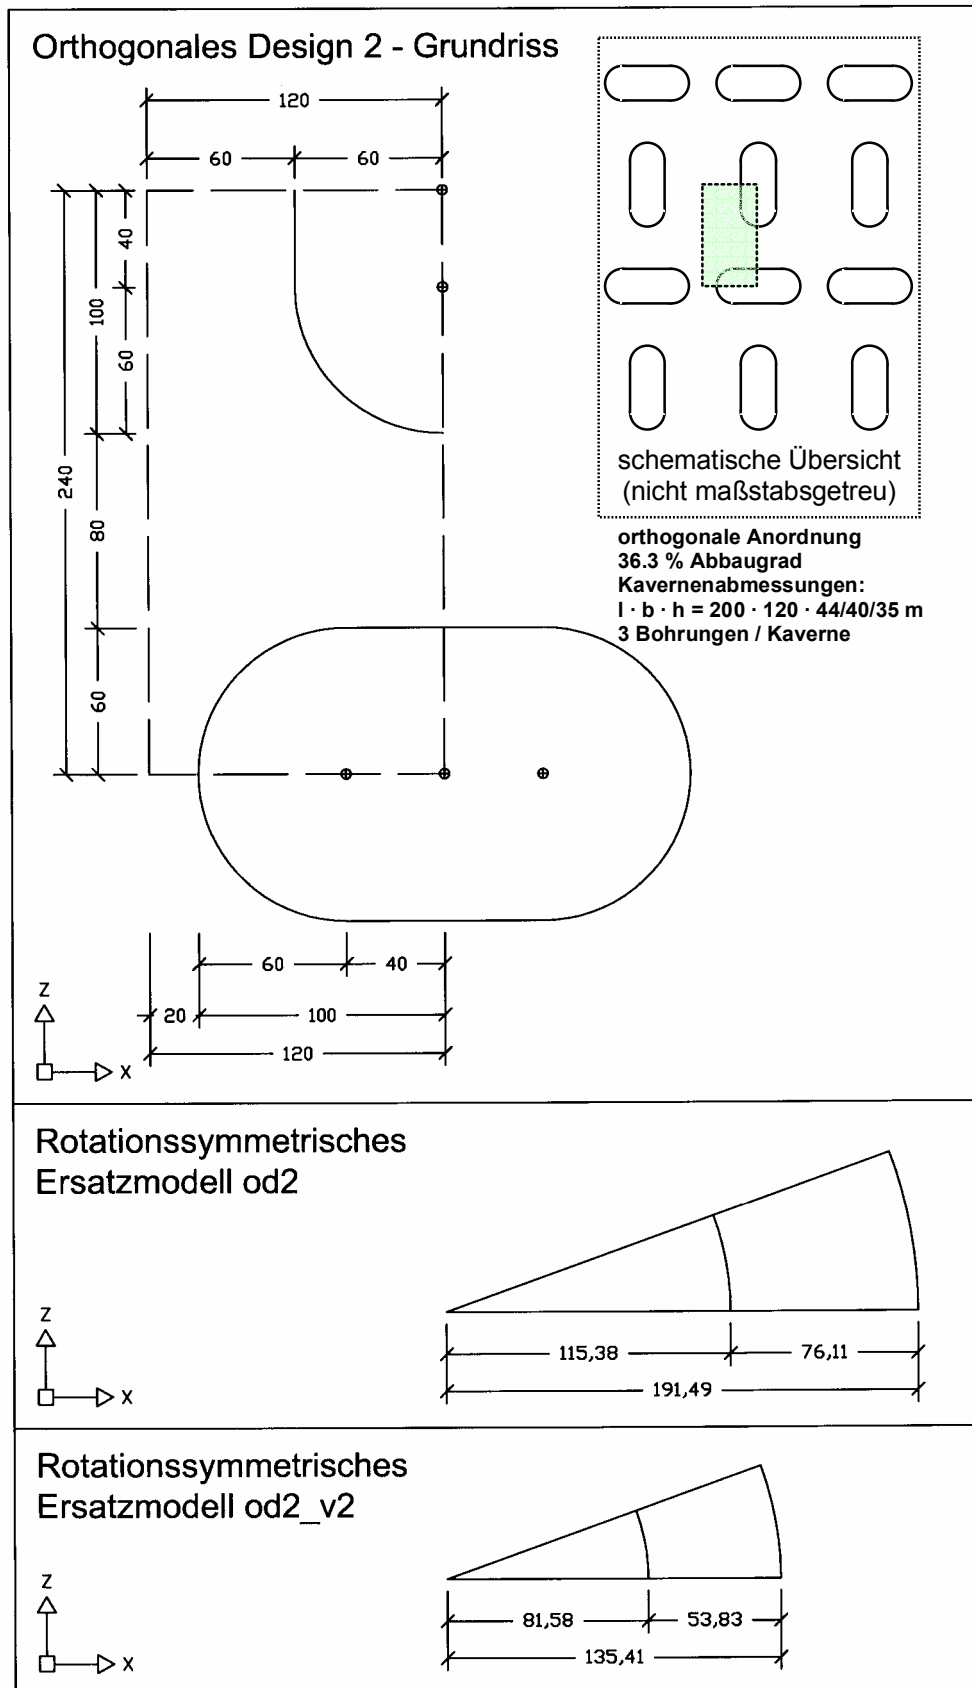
Orthogonales Design 2 – Grundriss und rotationssymmetrische Ersatzmodelle
